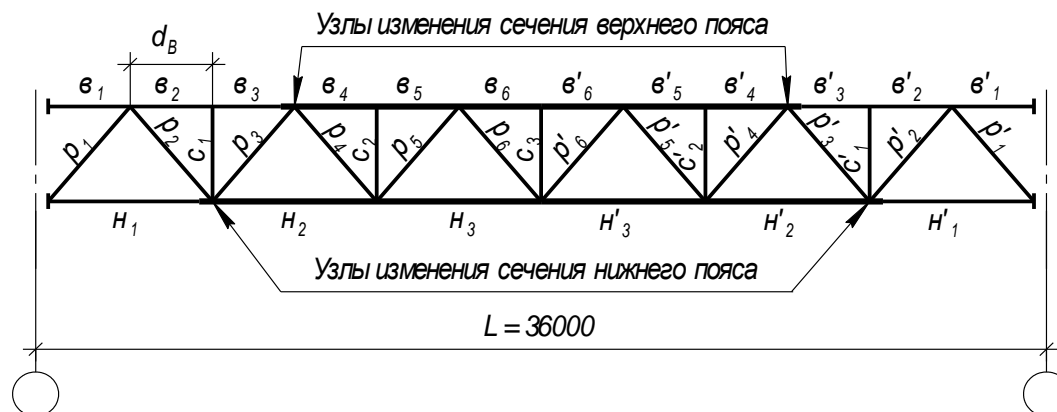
К определению расчетных усилий в стержнях фермы
